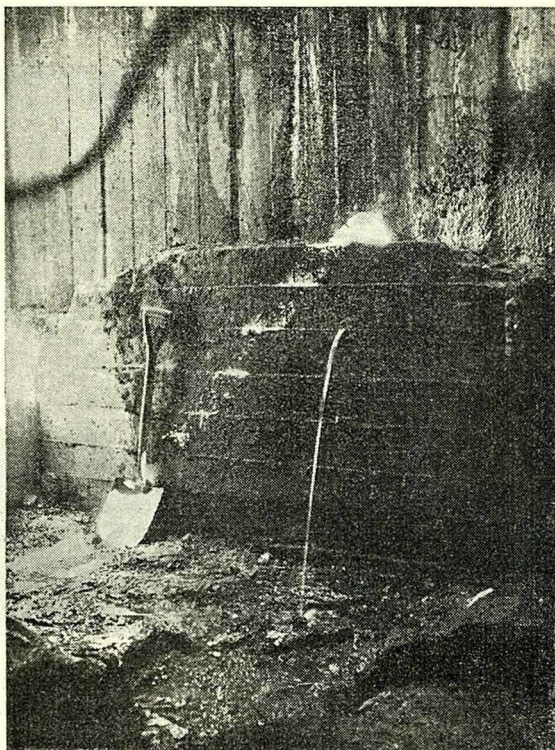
Interior de la ataguía, con el muro perimetral terminado.
